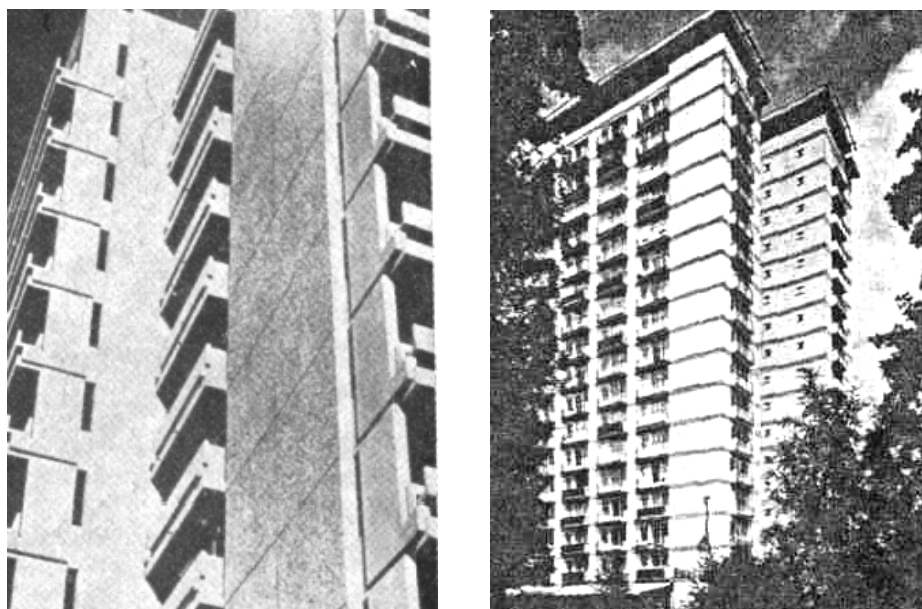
y 1.1.15- Sistema Allbeton de Suecia, a base de muros portantes de concreto
